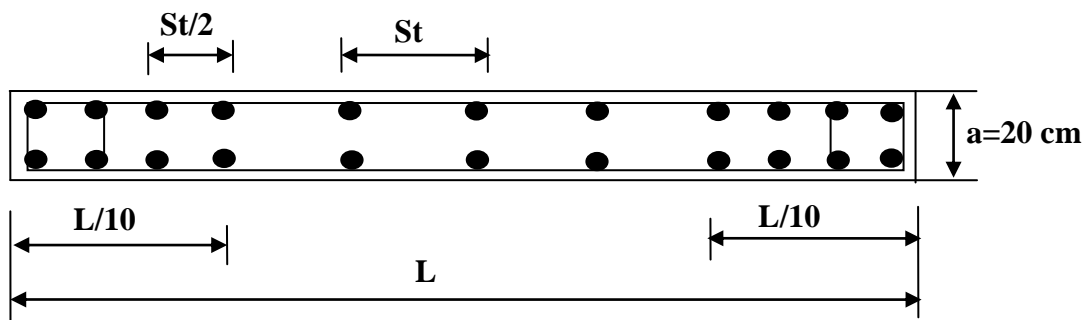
Disposition des armatures verticales dans les voiles.
